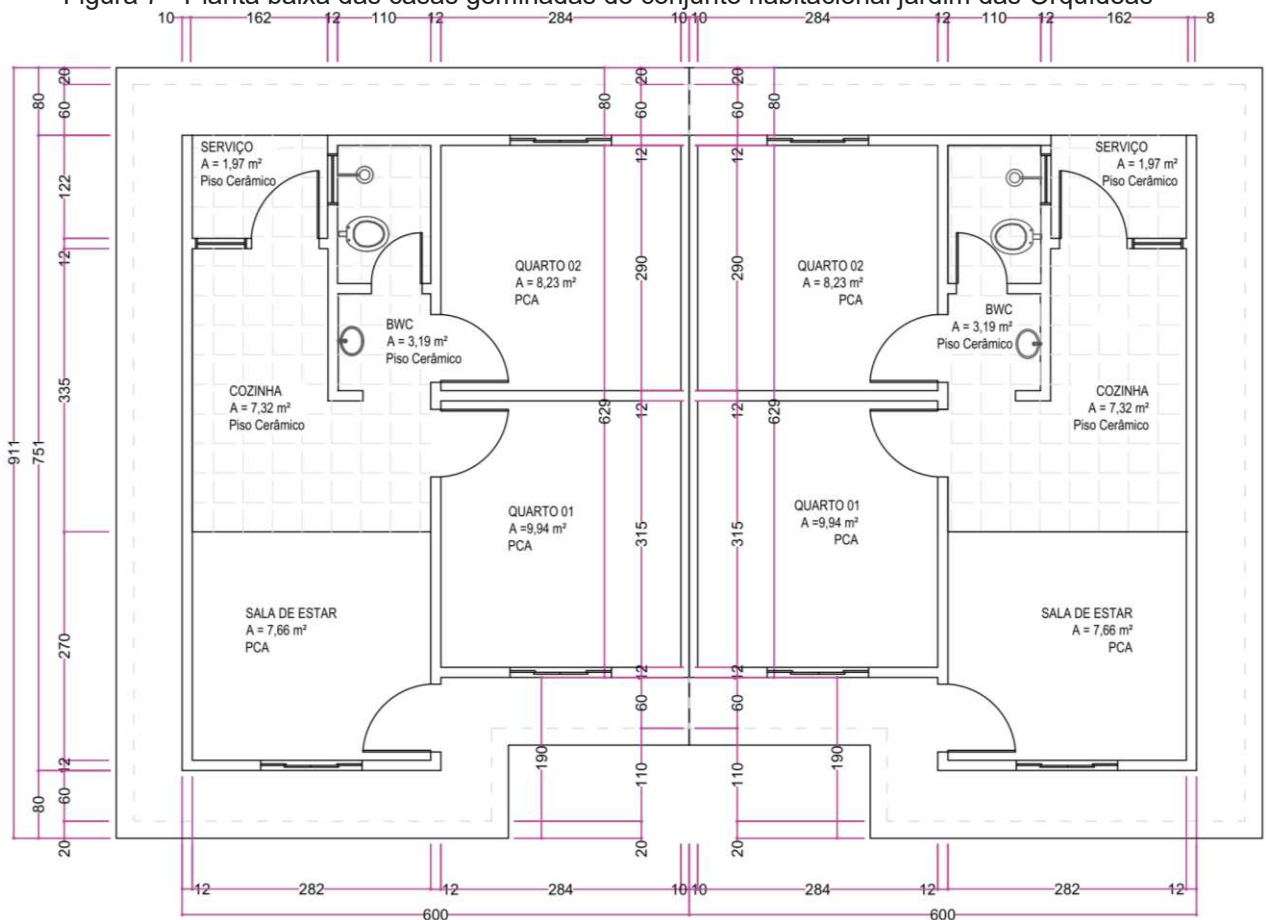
Planta baixa das casas do conjunto habitacional jardim das Orquídeas
